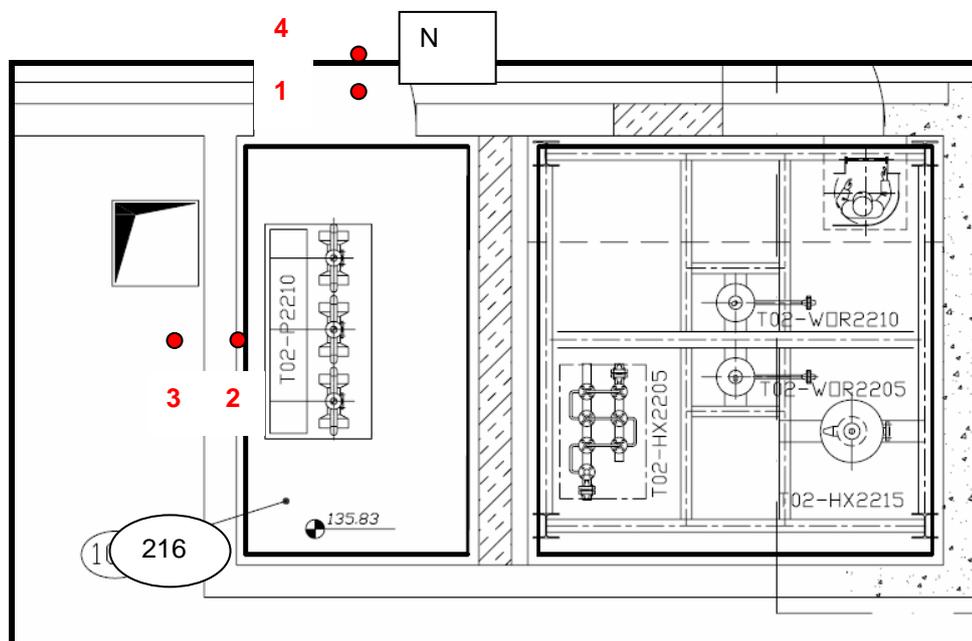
Vista in pianta dei locali L216 ed L106
